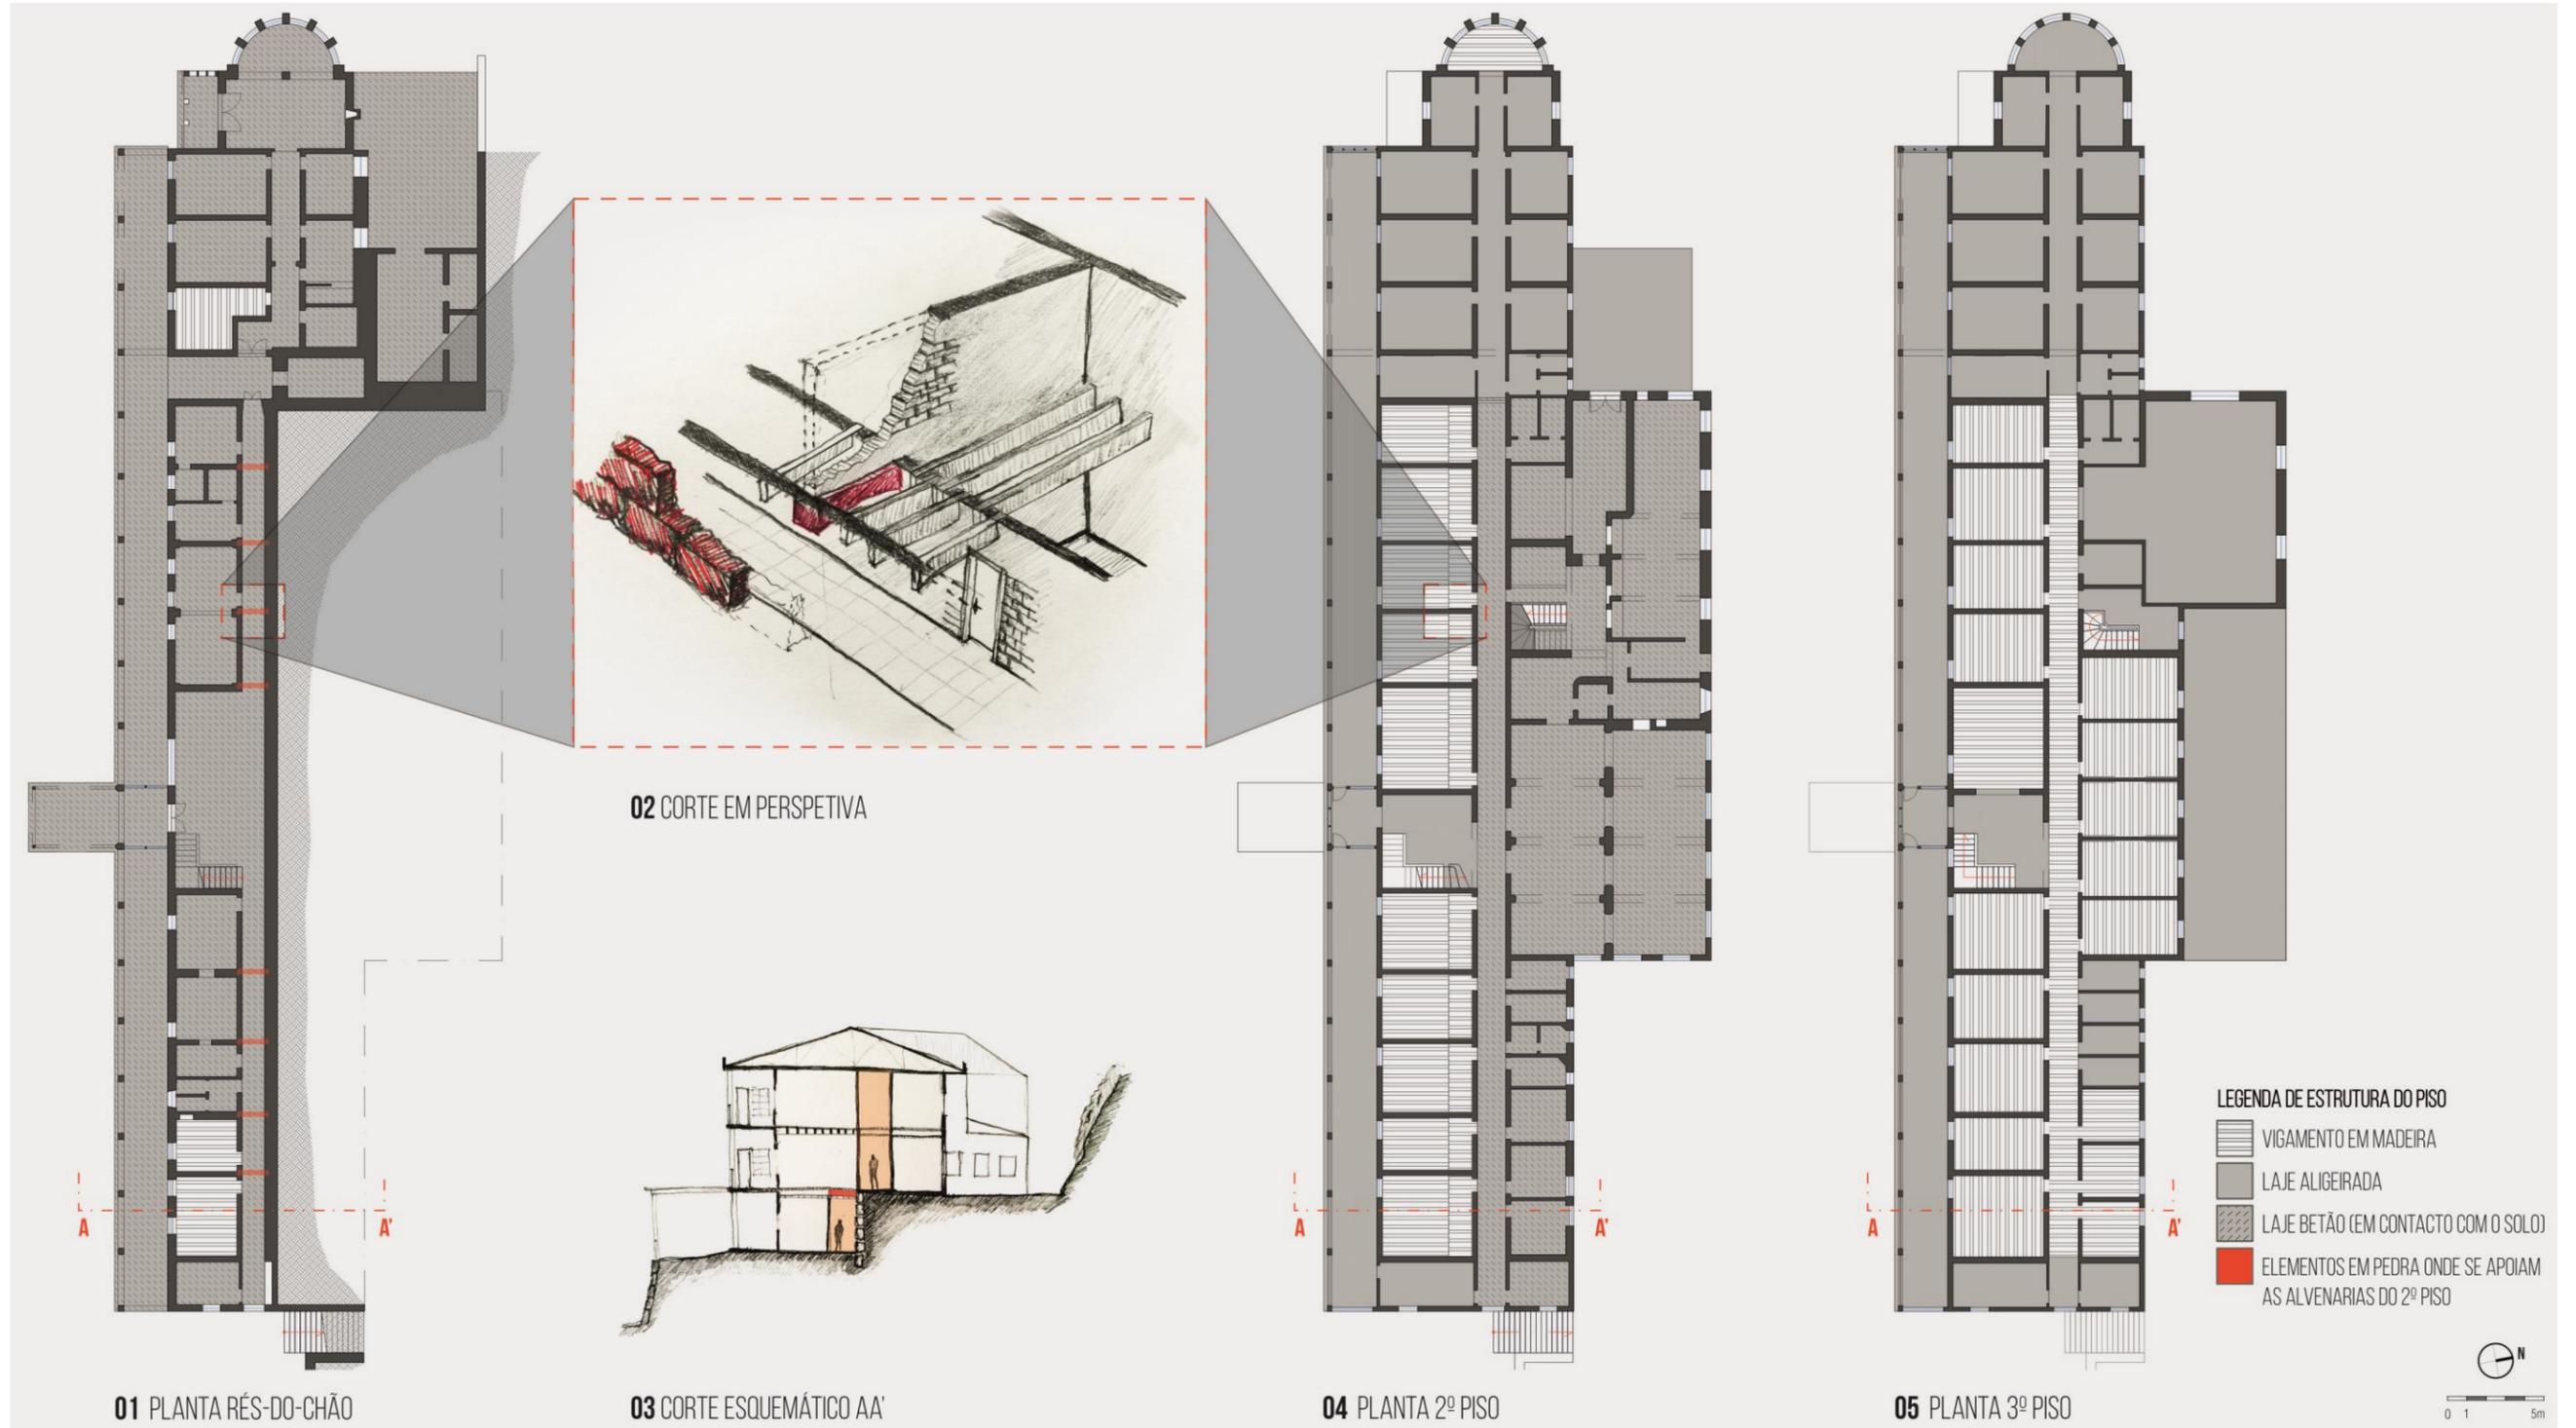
Definição Material – Plantas de estrutura dos pavimentos e esquemas – rés-do-chão, 2º e 3º pisos (desenvolvida a partir do levantamento *in situ*).
